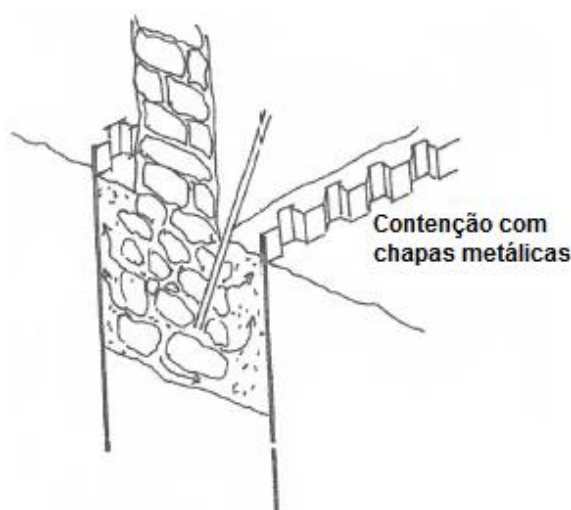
Esquema da consolidação com auxílio de chapas metálicas [adaptado de 55]
